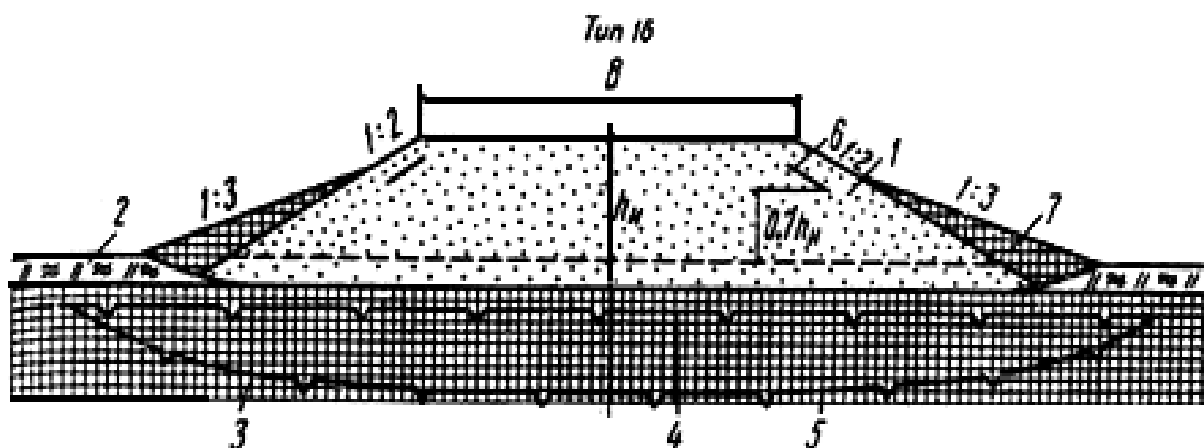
Поперечный профиль насыпи на торфяных грунтах: 1 – грунт насыпи; 2 – мохорастительный покров; 3 – вечномёрзлый торф; 4 – ВГВМ в естественных условиях; 5 – то же после постройки насыпи; 6 – укрепление верхней части откоса торфом; 7 – теплоизоляция откоса торфом
